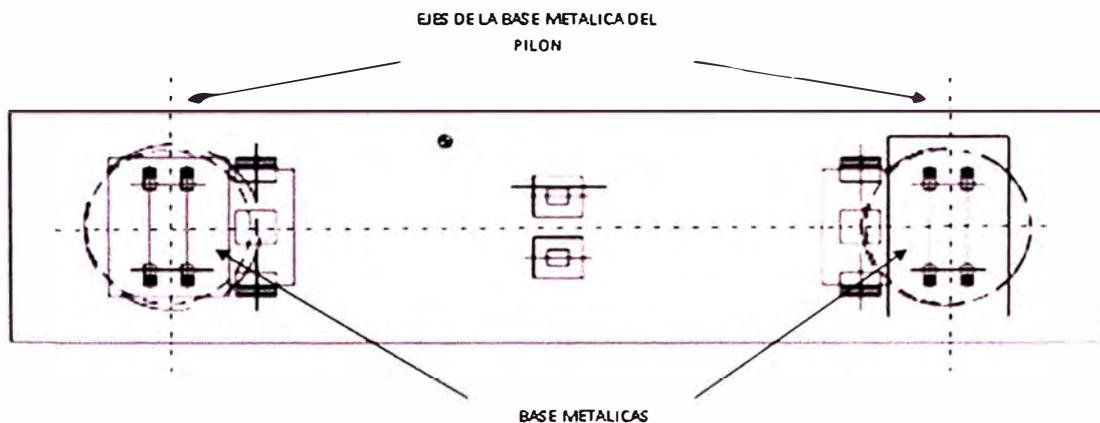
ESQUEMA DE EJES DE BASE METÁLICA DEL PILÓN
